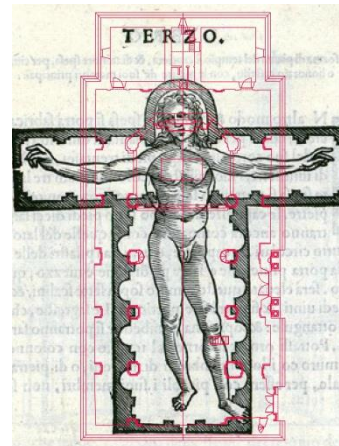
Planta del edificio sobre dibujo de Pietro Cataneo.
